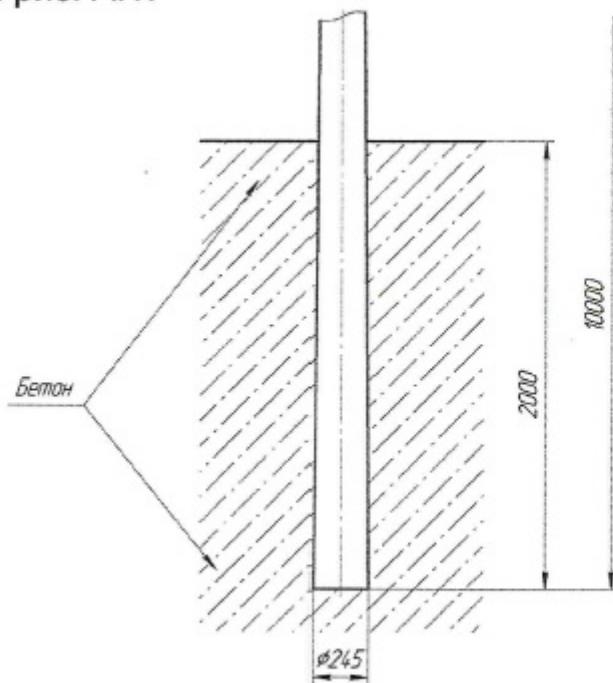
Способ установки прямостоечной опоры в бетонный фундамент
